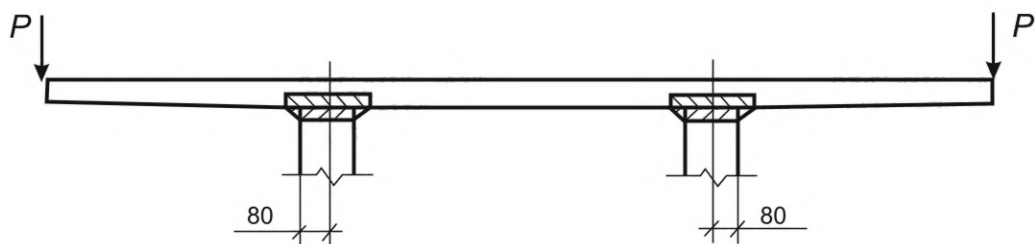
Схема испытания ступеней типоразмеров ЛСС 24
